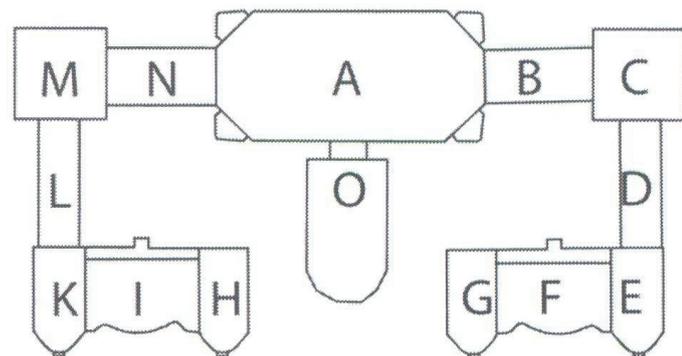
Lageplan mit Bezeichnung der einzelnen Gewächshäuser [32]
